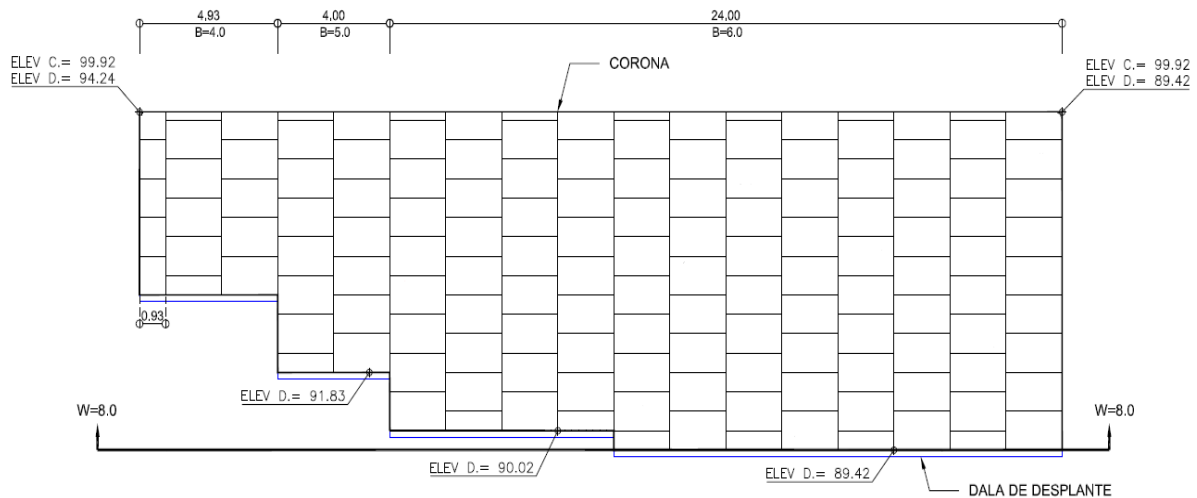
Propuesta del muro mecánicamente estabilizado.
